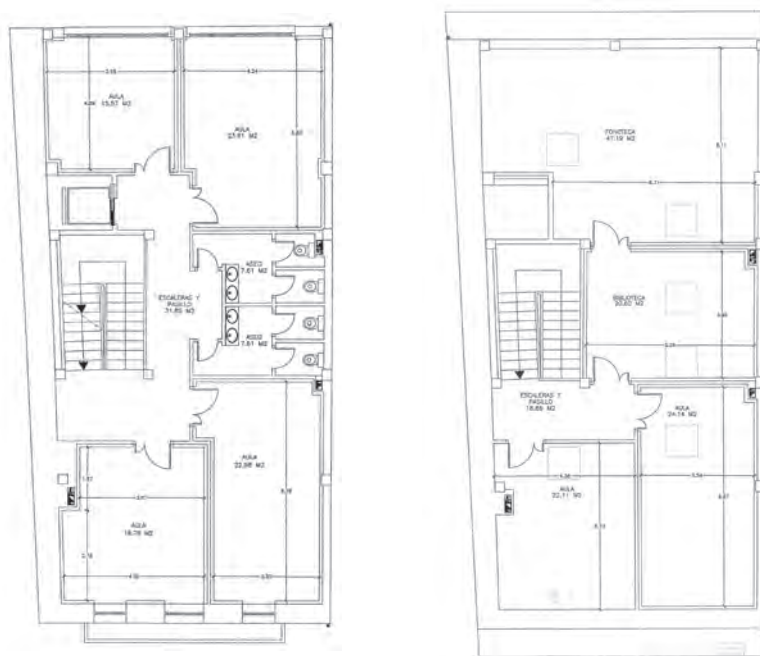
18. 1996 PLANTA PRIMERA Y PLANTA BAJOCUBIERTA
